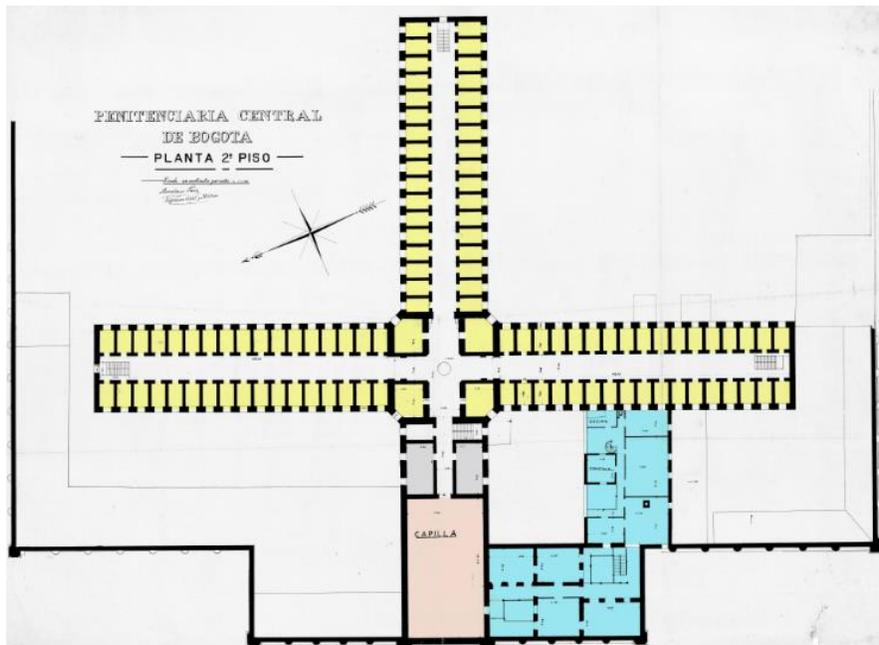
Modificaciones a la Penitenciaría - Planta piso 2
